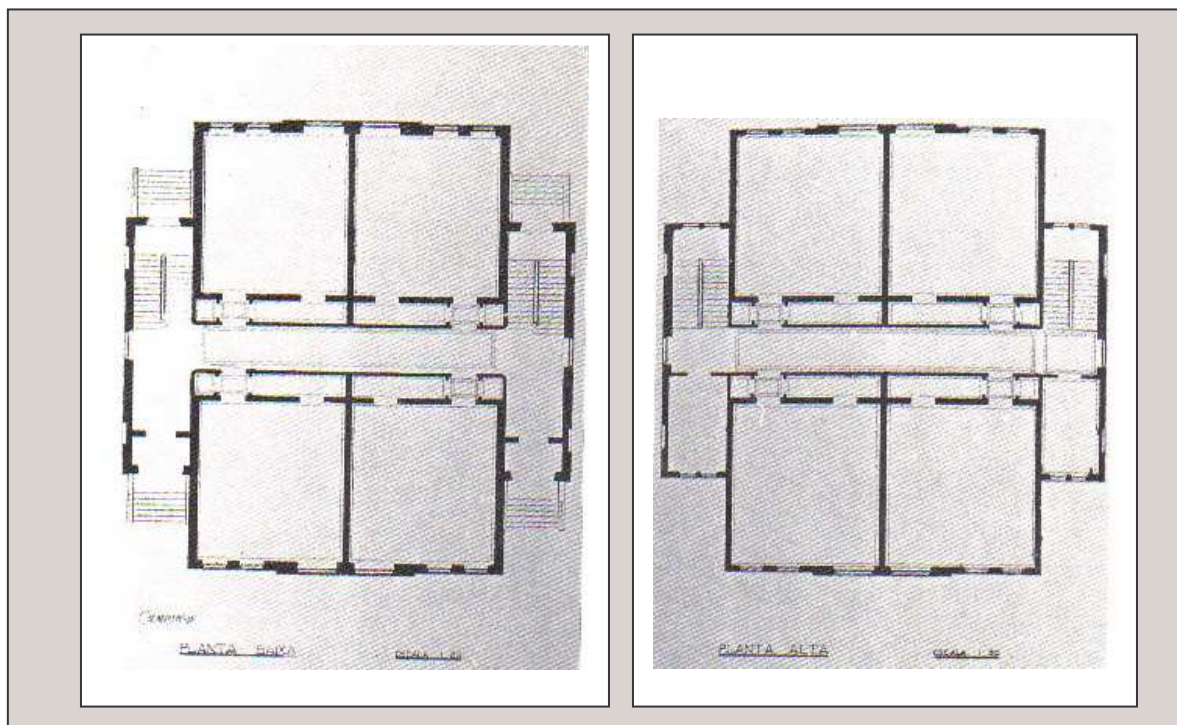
Ilustração da planta baixa original do Primeiro Grupo Escolar de Campinas. À esquerda, o pavimento térreo e à direita, o superior.
